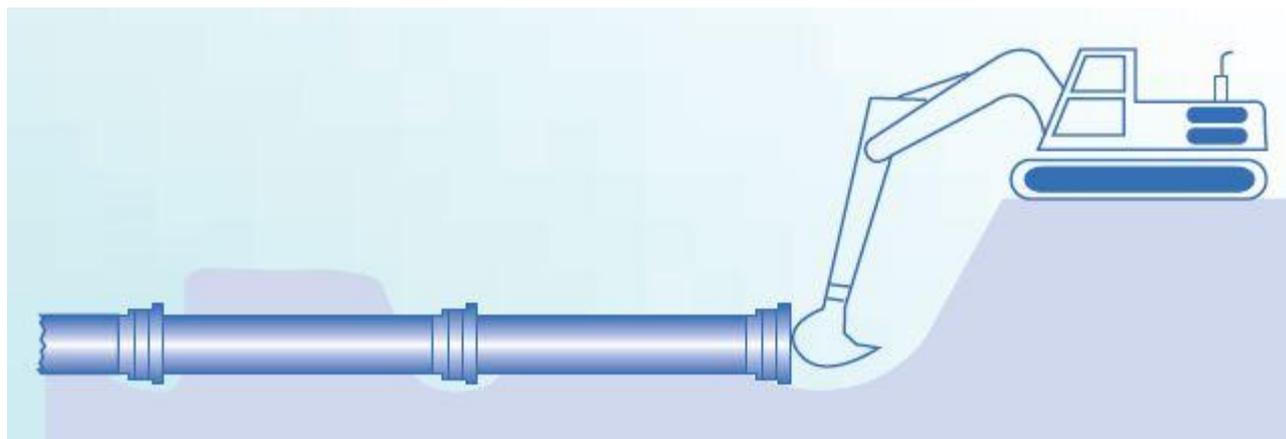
Assemblage des tuyaux : Méthode du pied-de-biche.
